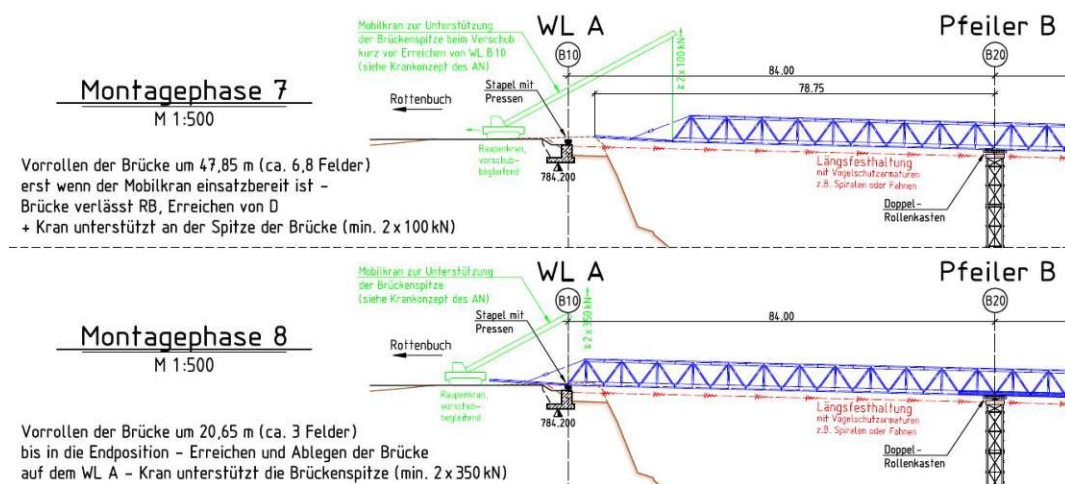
Ausschnitt aus dem Montageplan zum Bau der Behelfsbrücke Echelsbach, Kranunterstützt [55]
